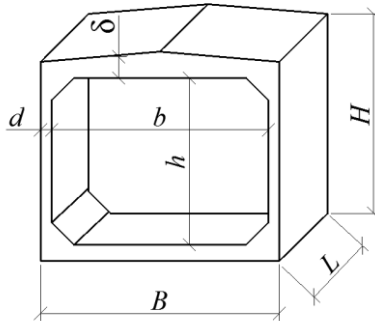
Звено железобетонное прямоугольное водопропускной
